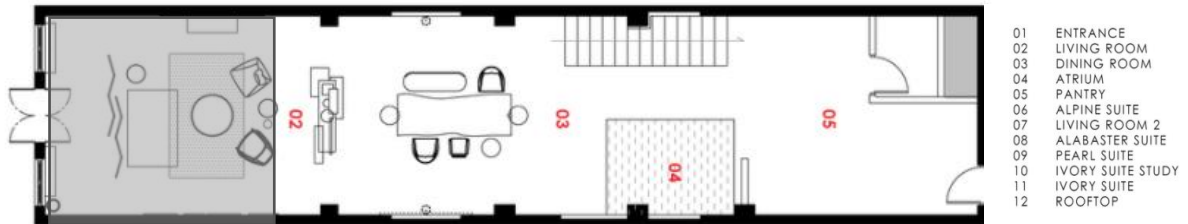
Planta e fotografias do piso 1 - archdayli65
